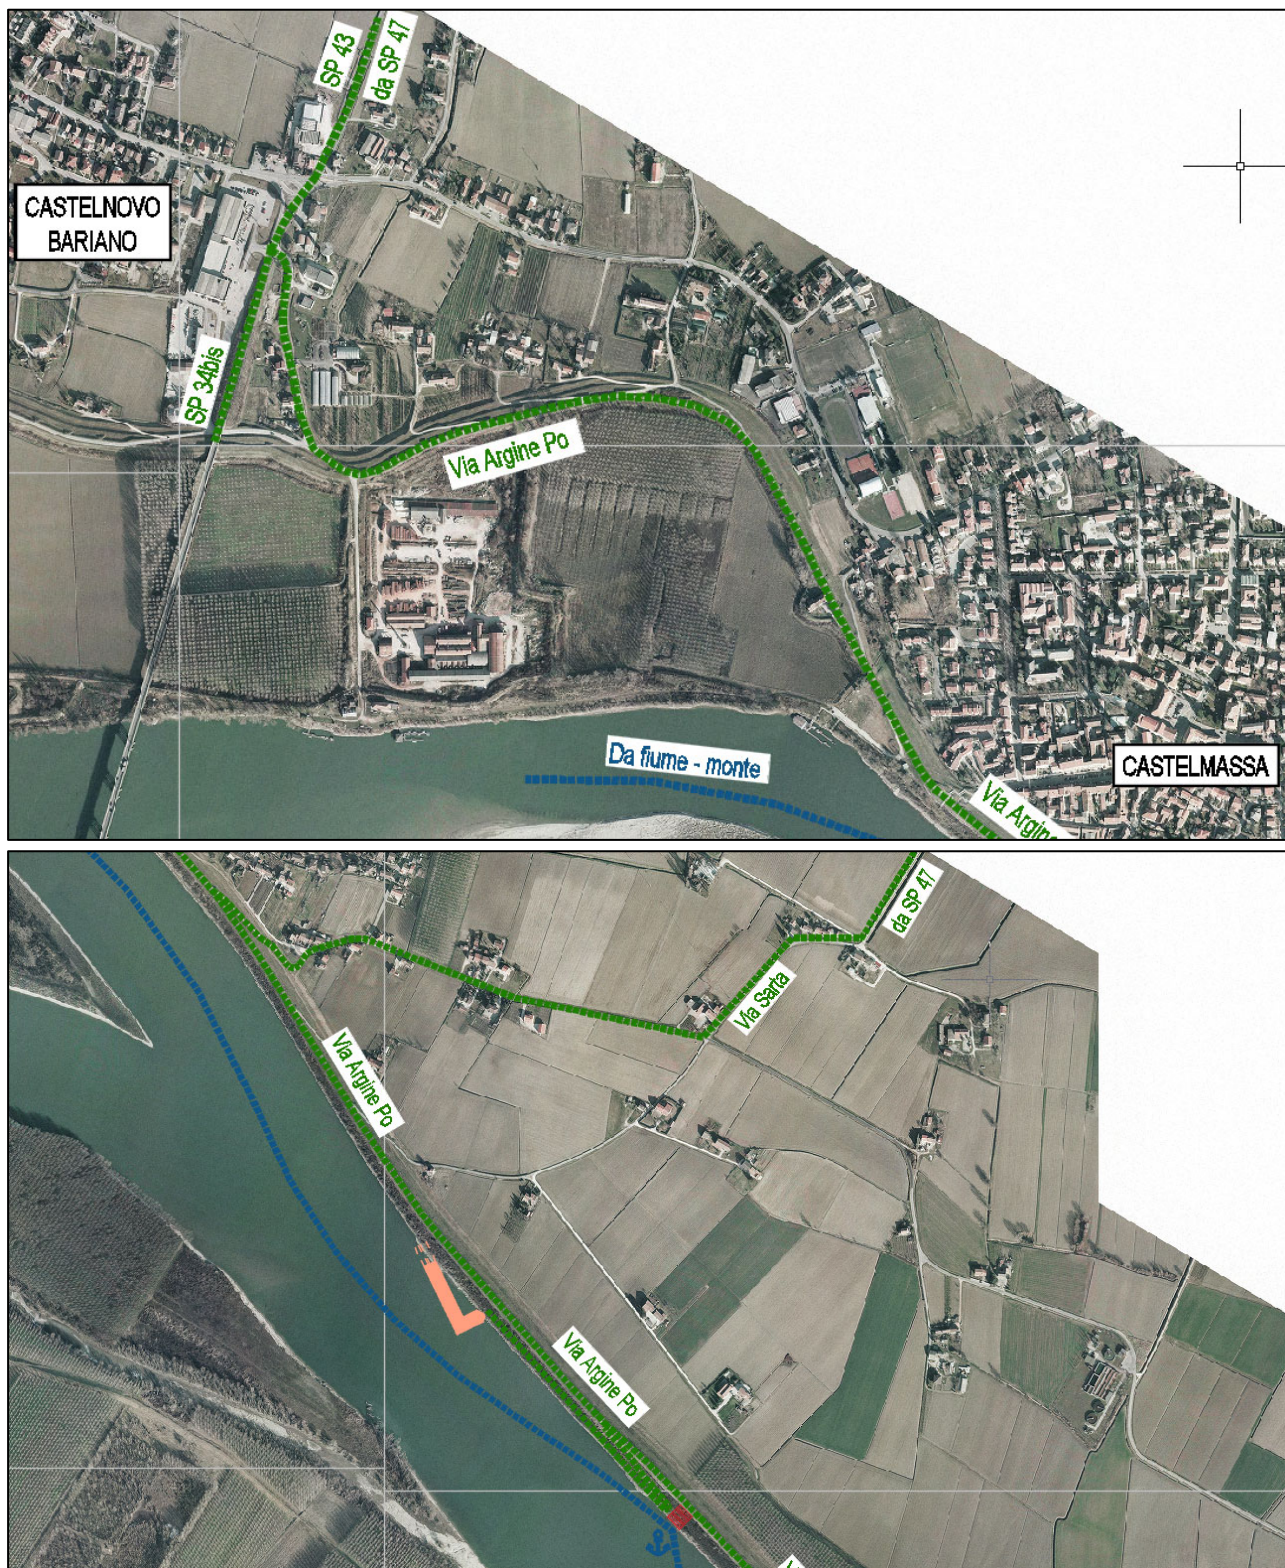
Planimetria degli accessi all'area di cantiere INTERVENTO 2
